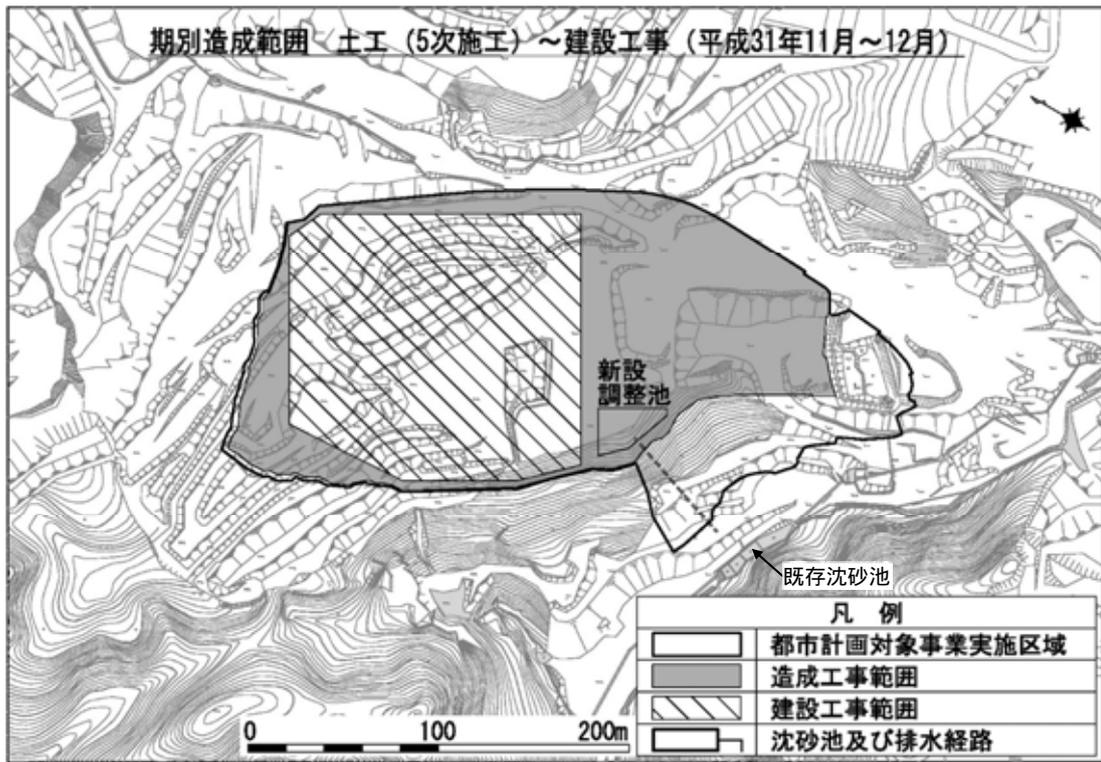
施工範囲（土工：5次施工～建設工事）
